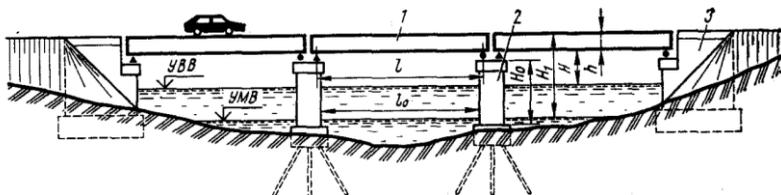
Балочный 3-пролетный мост: 1 – пролетное строение; 2 – быки; 3 – береговые устои; l – длина пролетного строения; l_0 – длина пролета в свету; h – высота пролетного строения; УВВ – уровень верховых вод; УМВ – уровень меженных вод
